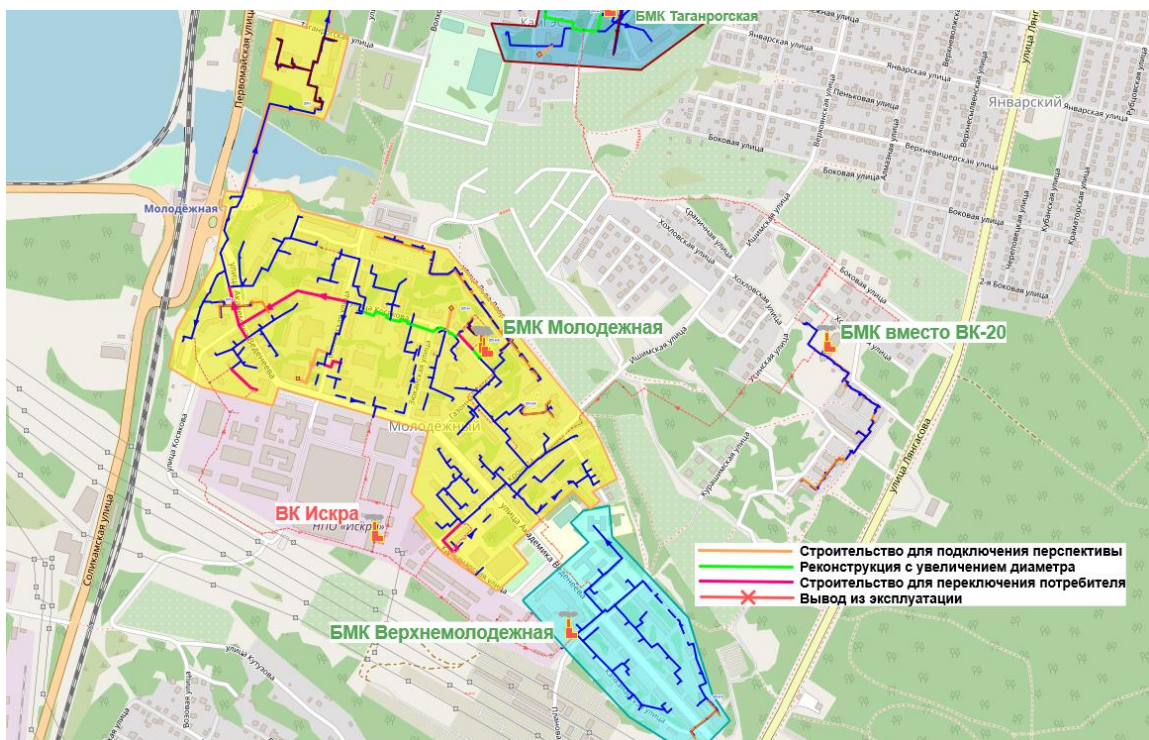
Строительство и реконструкция тепловых сетей при переключении нагрузок котельной ВК Искра на ВК Молодежный и БМК Верхнемолодежная
